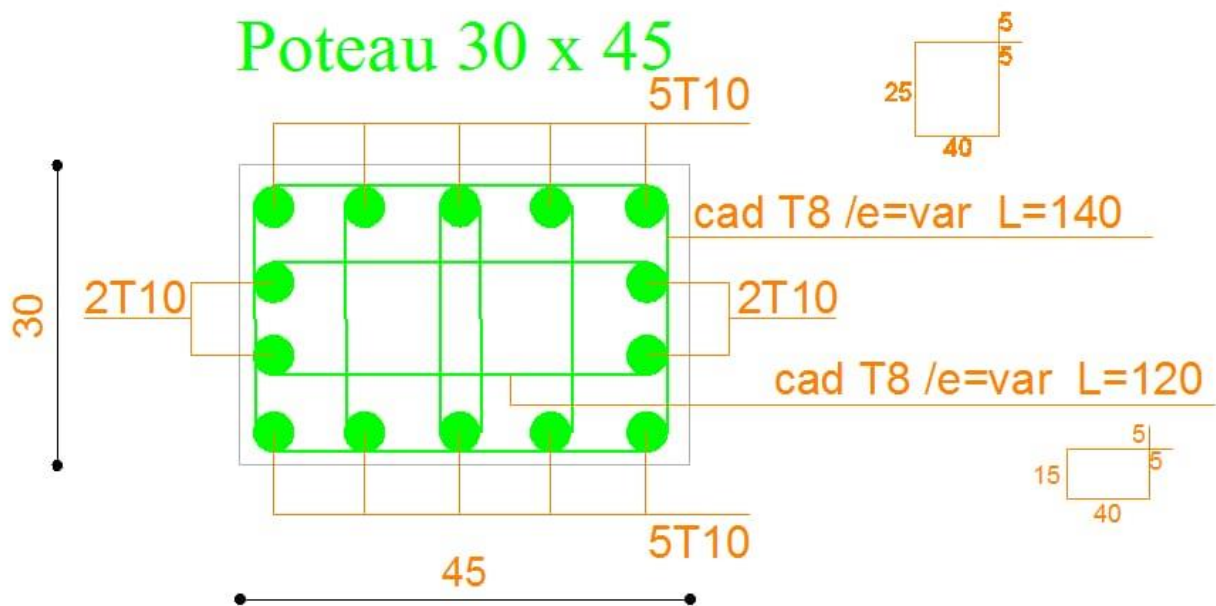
Schéma de ferrailage des poteaux 30x45.
